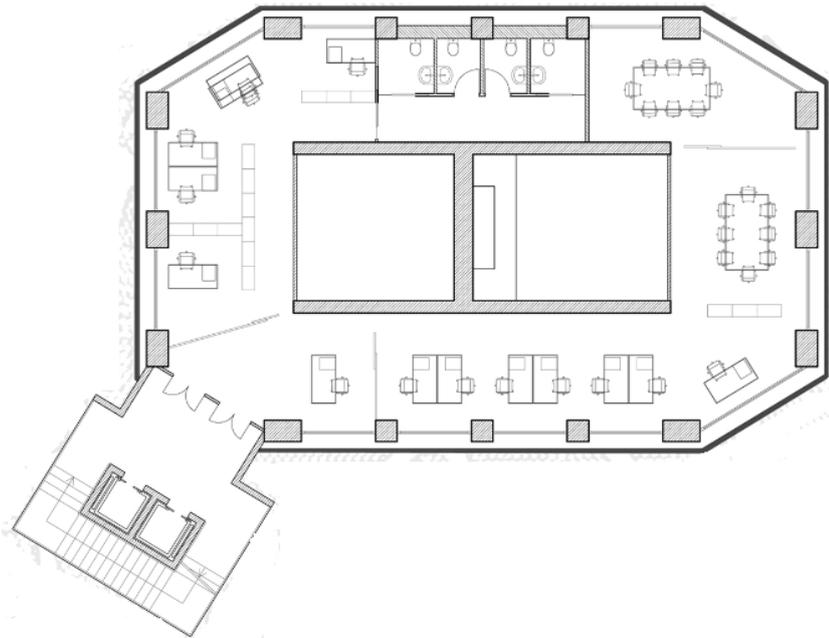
Planimetria della torre serbatoio secondo la soluzione progettuale individuata
